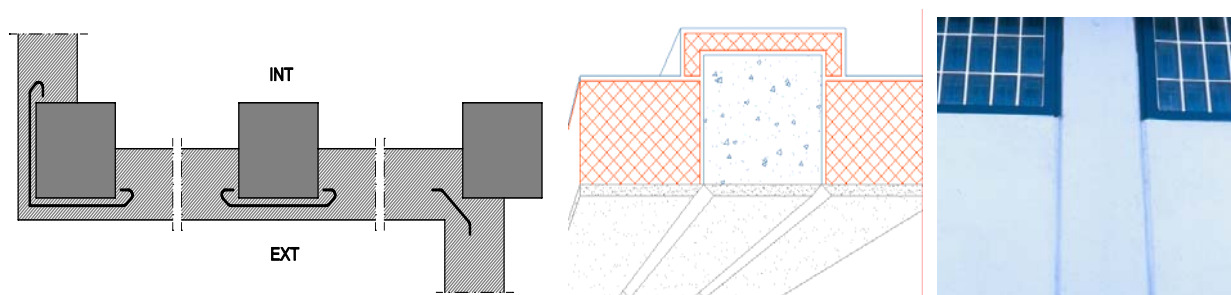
Encuentro con pilares; propuesta del CTE y propuesta alternativa
